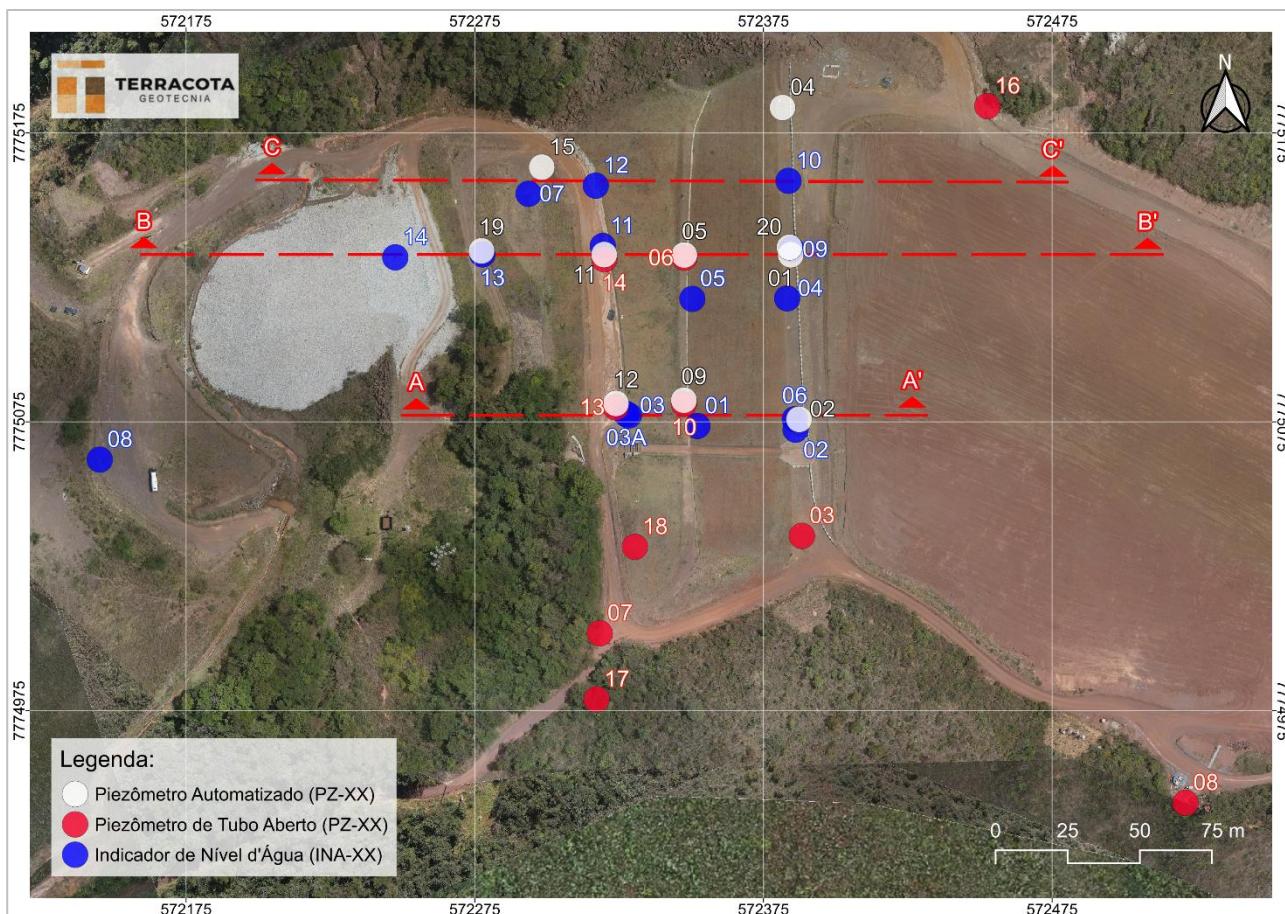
Seções Instrumentadas Barragem B1 – Mina Ipê – Planta.
